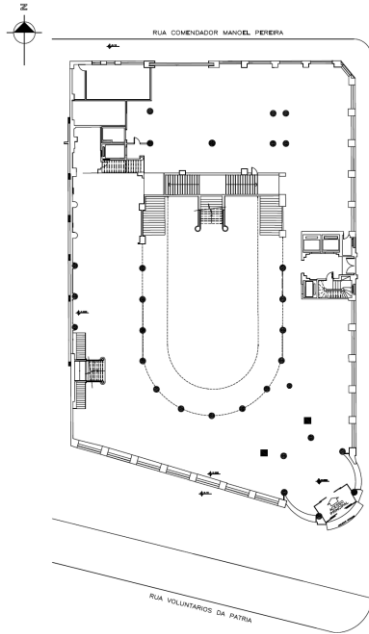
Magazine Mesbla, Porto Alegre(1944). Planta baixa térreo.
